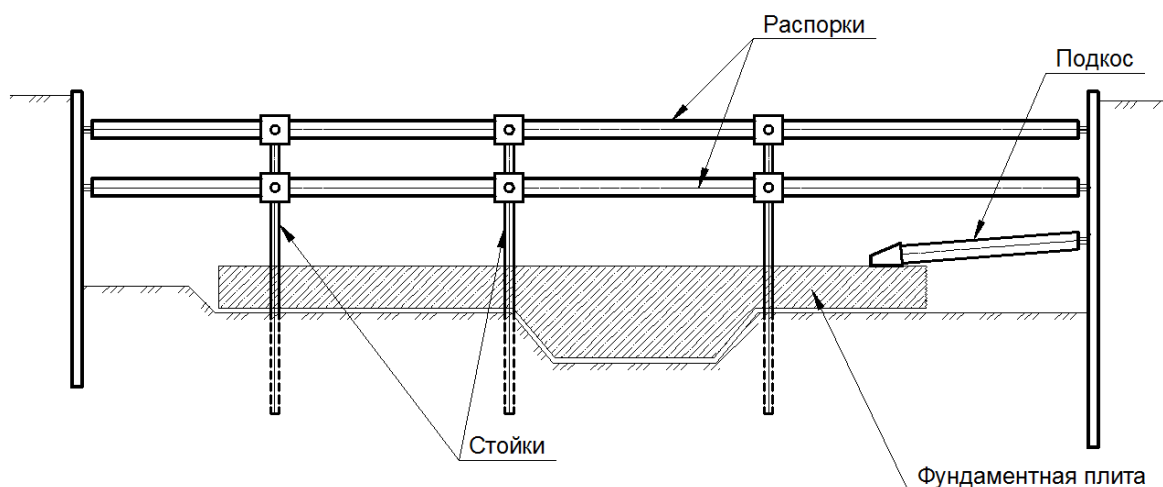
Пример крепления ограждающих конструкций котлована с использованием распорной системы
